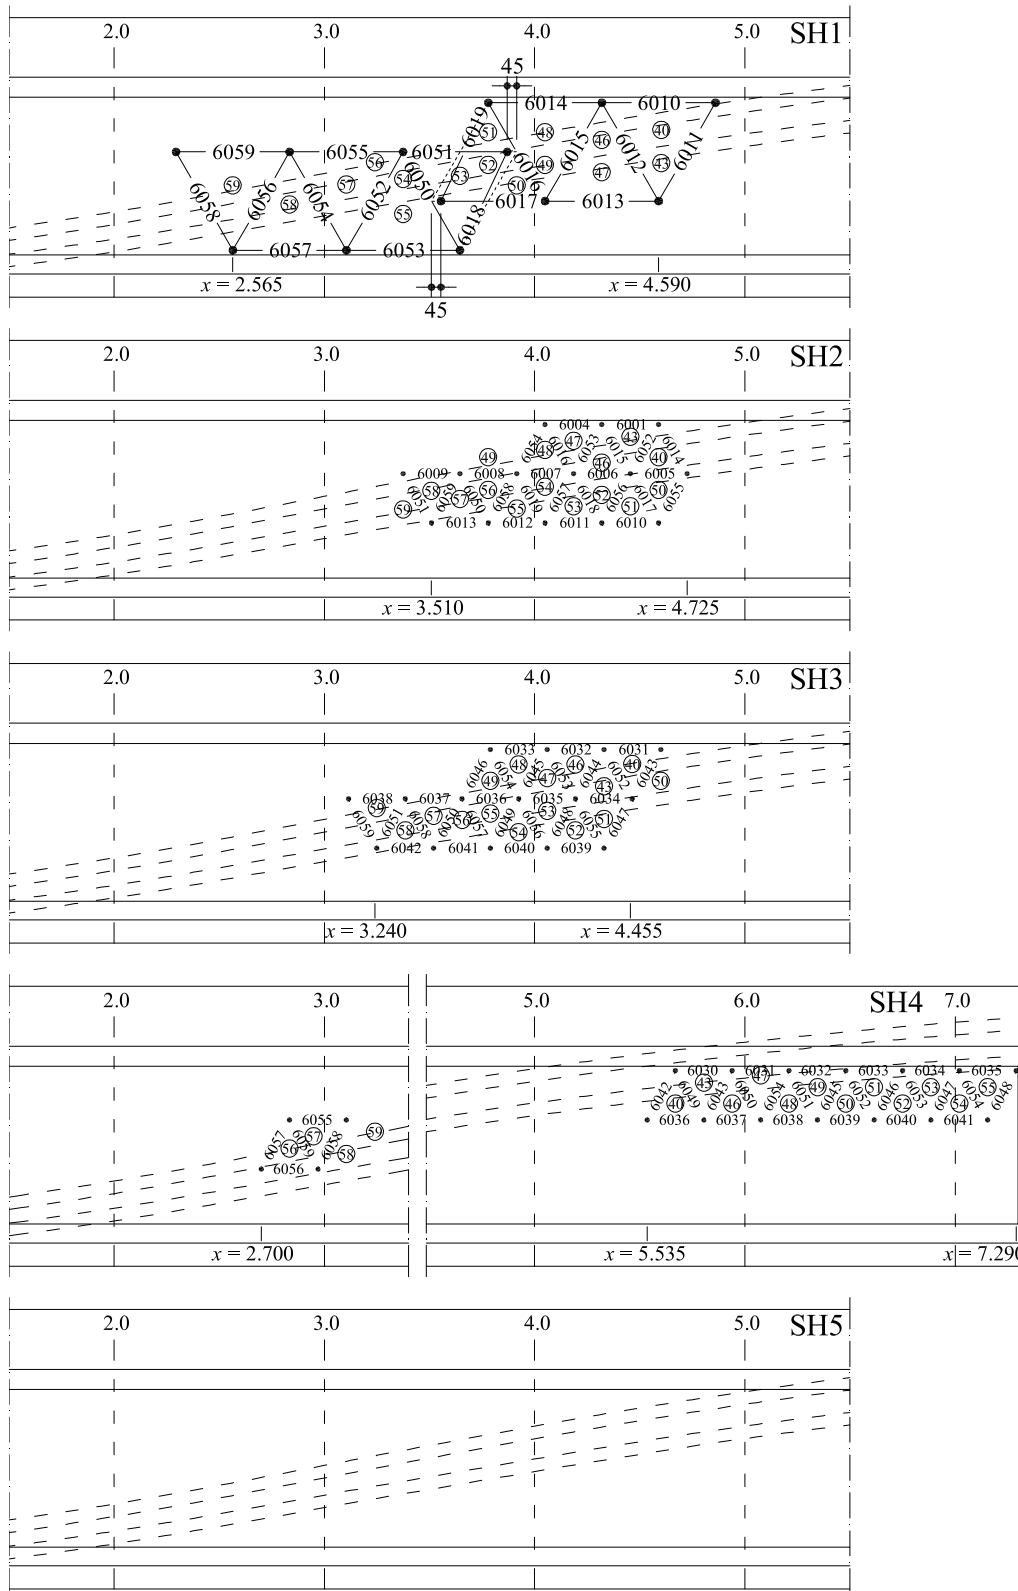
Poutres SH1 à SH5, partie Sud : emplacement des capteurs dans la zone susceptible de rupture mesurant l’allongement local du béton de l’âme et la fissuration interne dans le plan de l’âme
